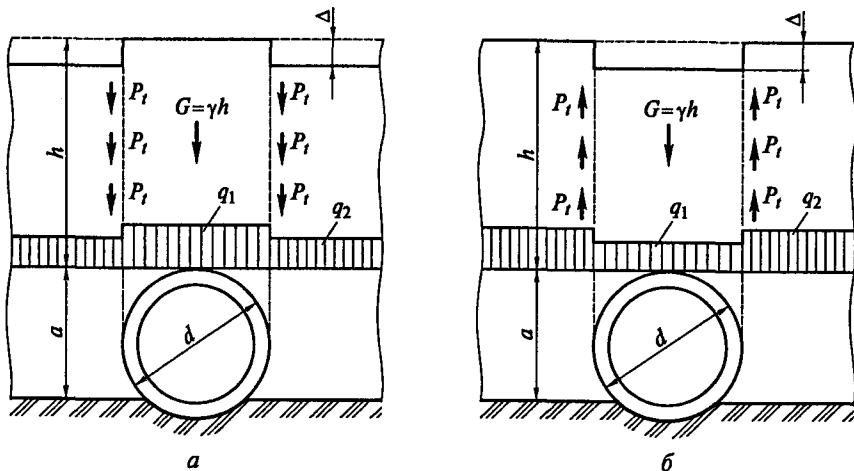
Схемы взаимных осадок насыпи над трубой и по ее бокам:
